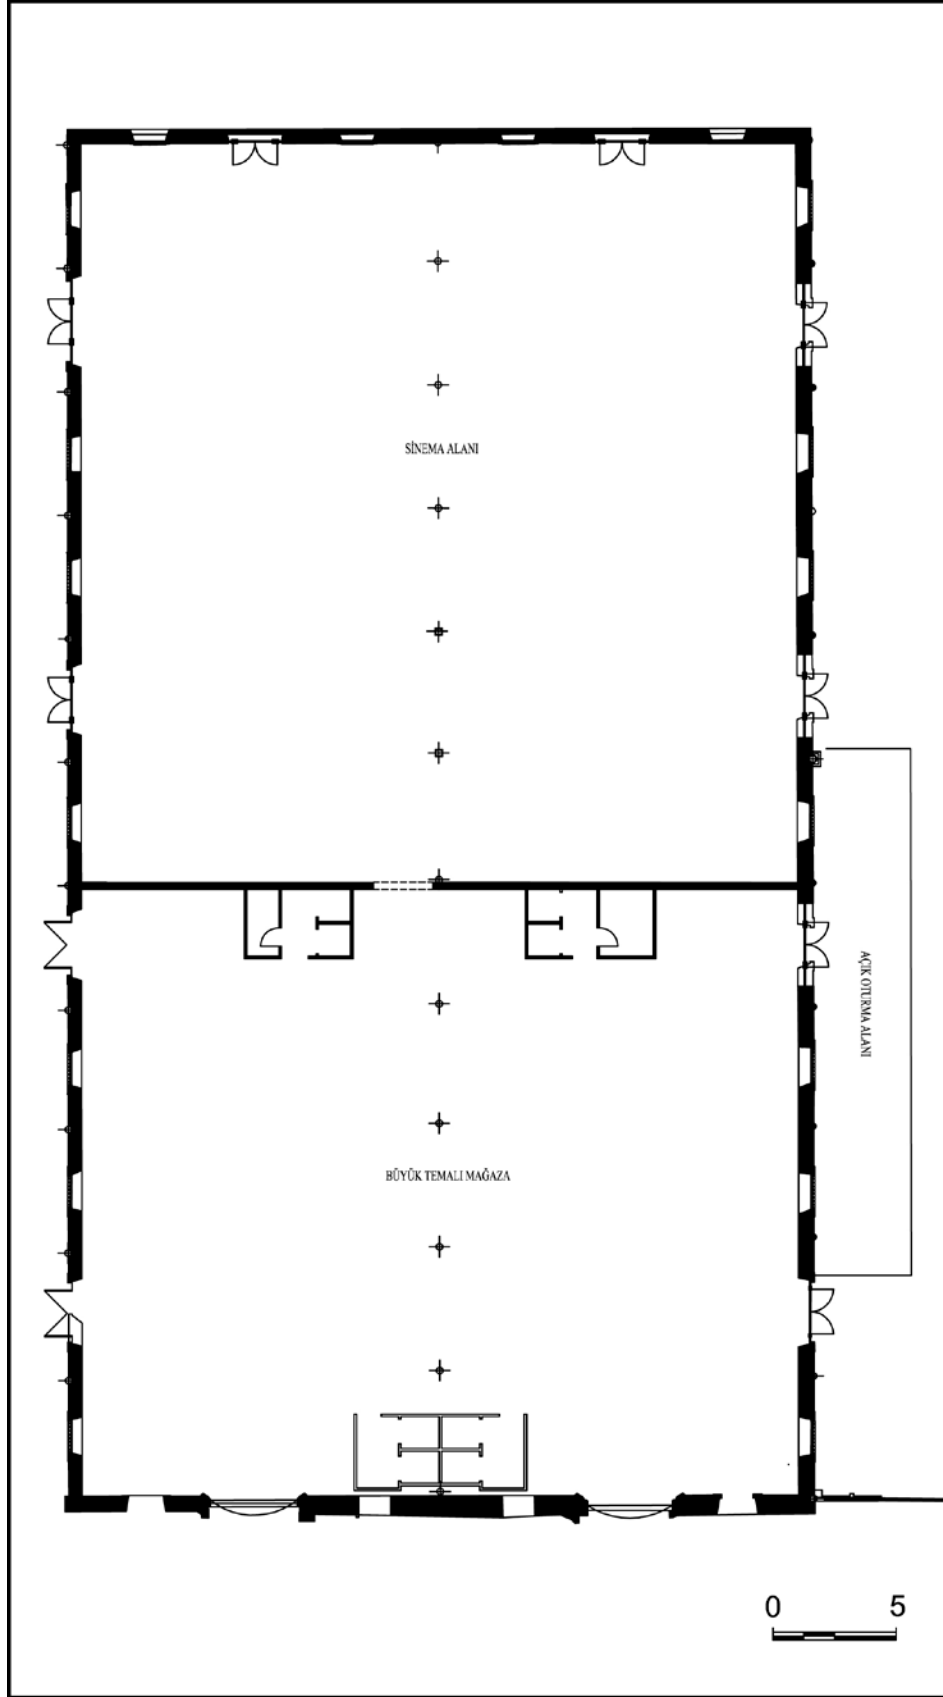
II. Dönem Hurda Ambarı 1 Binası Plan Şeması
